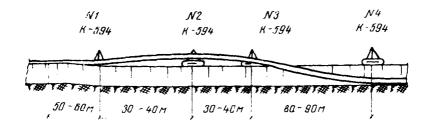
Размещение межанизмов в колонне при укладке изолированного трубопровода
